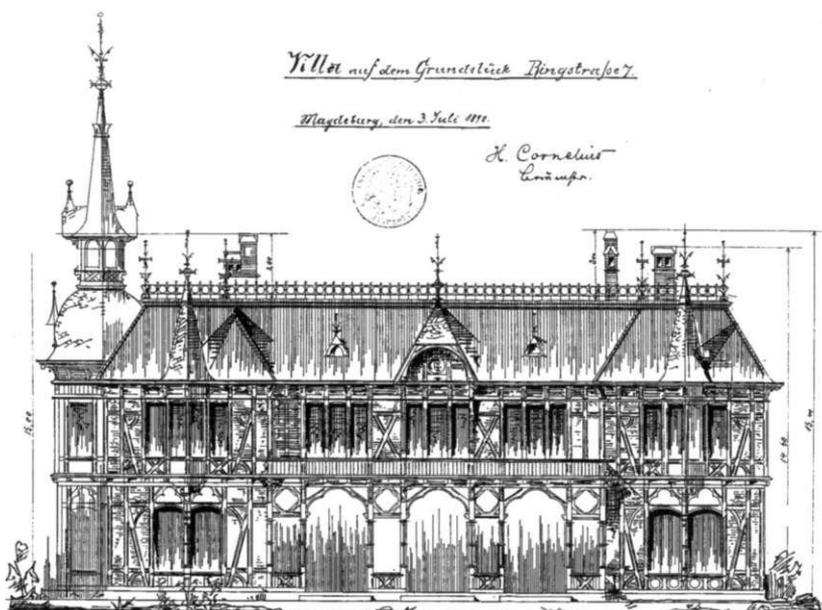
Liebknechtstraße 14, Fassadenentwurf, Gartenansicht
